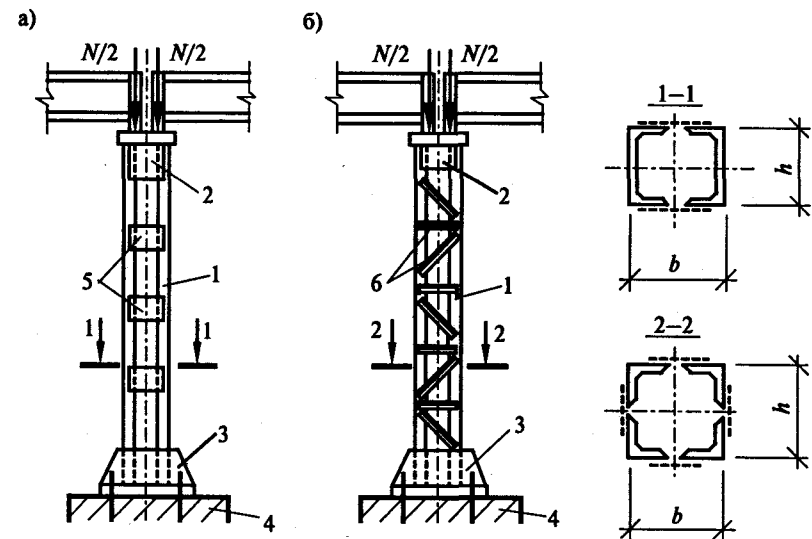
Сквозные центрально-сжатые колонны: а) соединение ветвей на планках; б) соединение ветвей решеткой из уголков; 1 — стержень; 2 — оголовок; 3 — база колонны; 4 — фундамент; 5 — планки; 6 — уголки
